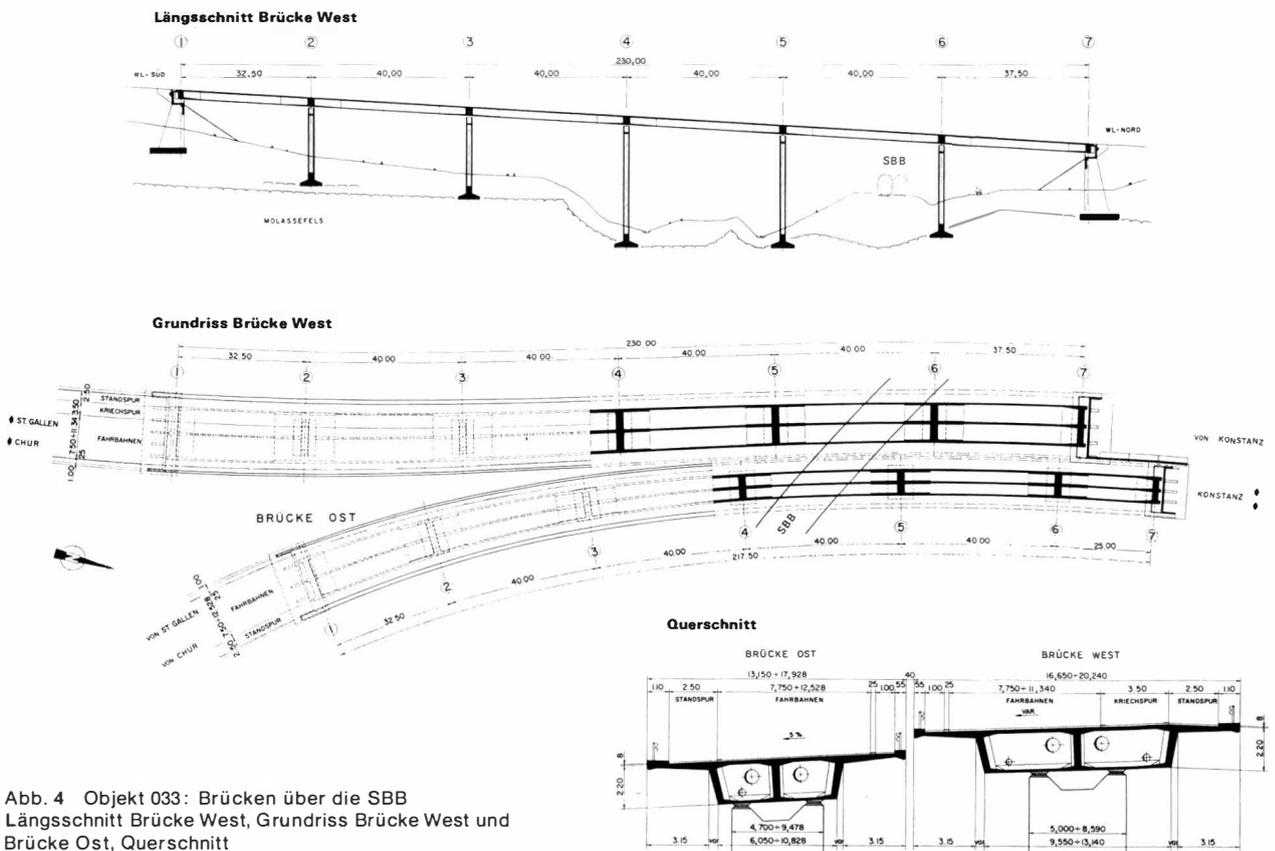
Objekt 033: Brücken über die SBB Längsschnitt Brücke West, Grundriss Brücke West und Brücke Ost, Querschnitt
